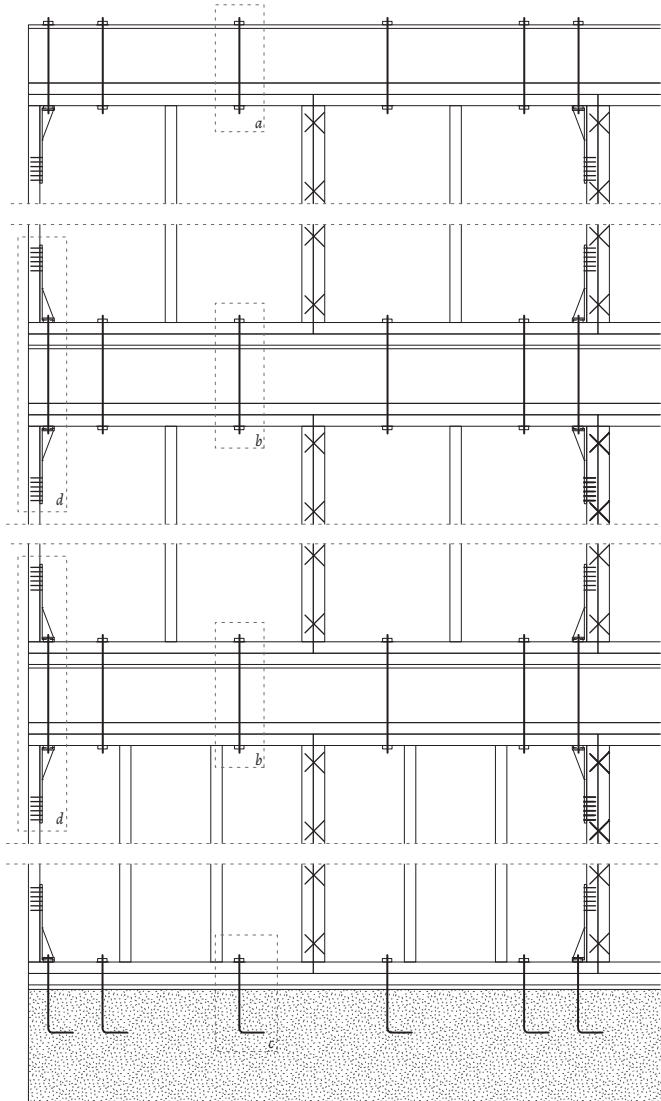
Elementos de fijación de la estructura de entramado ligero.
